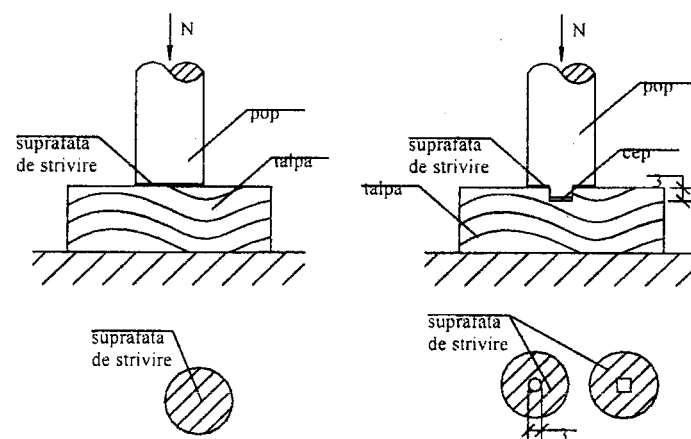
Stabilirea suprafețelor de strivire ale tălpilor sub popi
